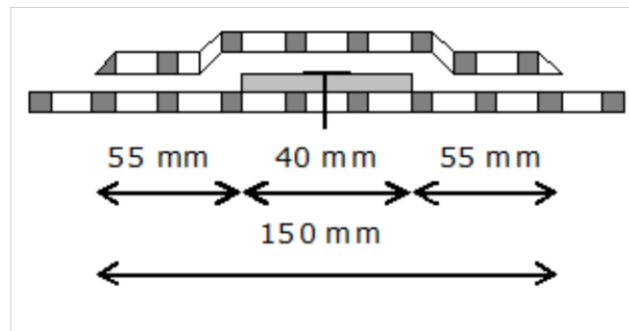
Coupe sur rangée de fixations complémentaires et bande de pontage (cas d'une largeur de plaquette 40 mm)
